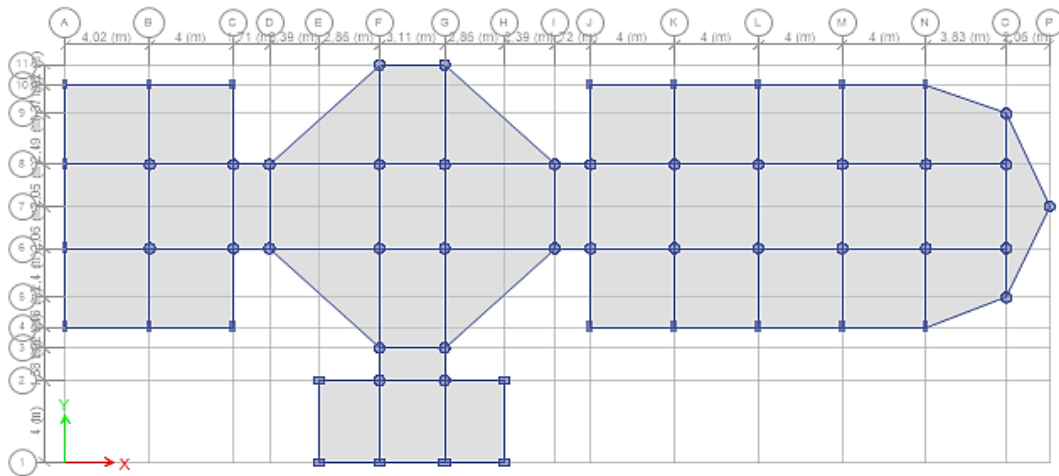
Modelo en ETABS de la sección 2 de la estructura.
